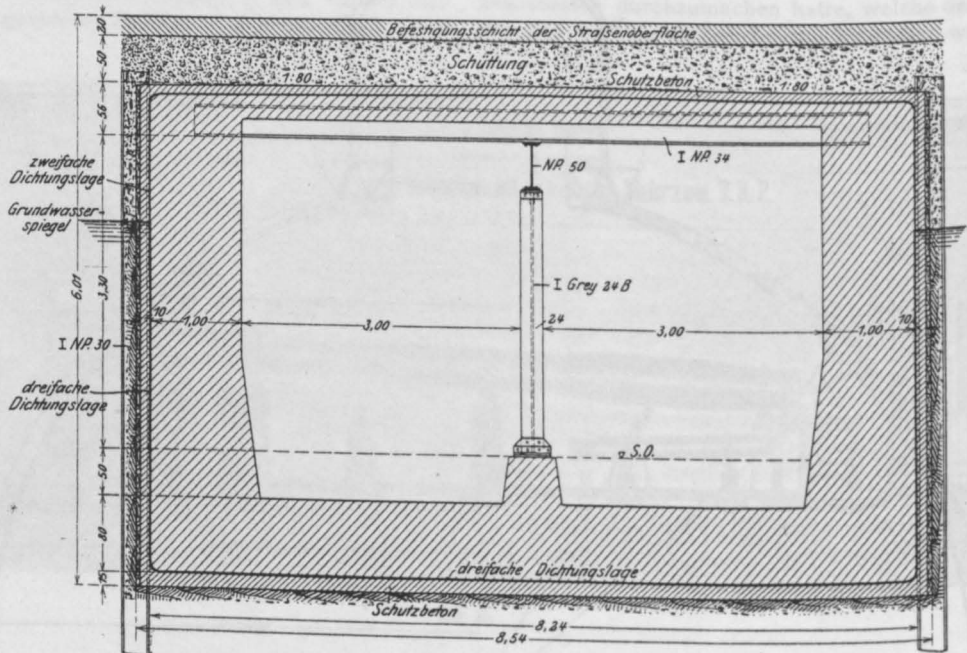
Untergrundbahntunnel nach Berliner Bauweise.
